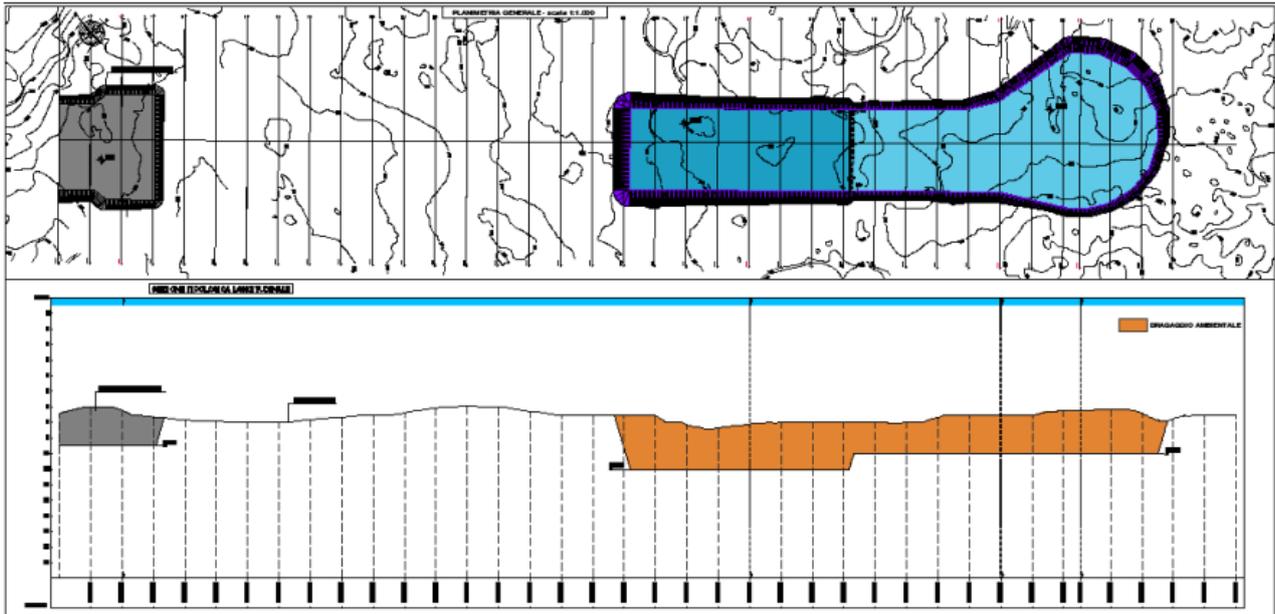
Planimetria e profilo longitudinale dei dragaggi ambientali
